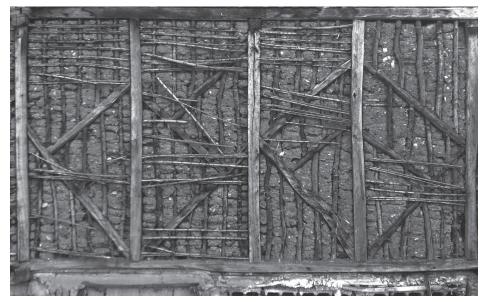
DETALLE DE ARRIOTRAMIENTO TIPO ZIGZAG, CENTRO DE LA CIUDAD DE AZOGUES, FUENTE: AUTOR
